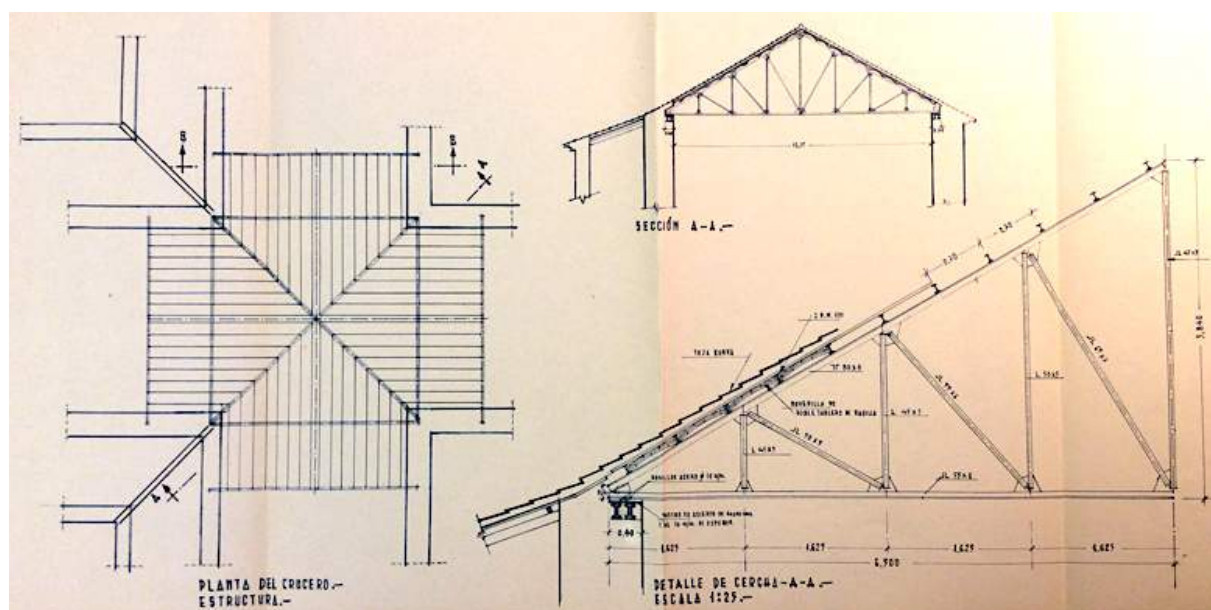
Planta y Sección del Proyecto de reconstrucción del crucero principal, 1967.
